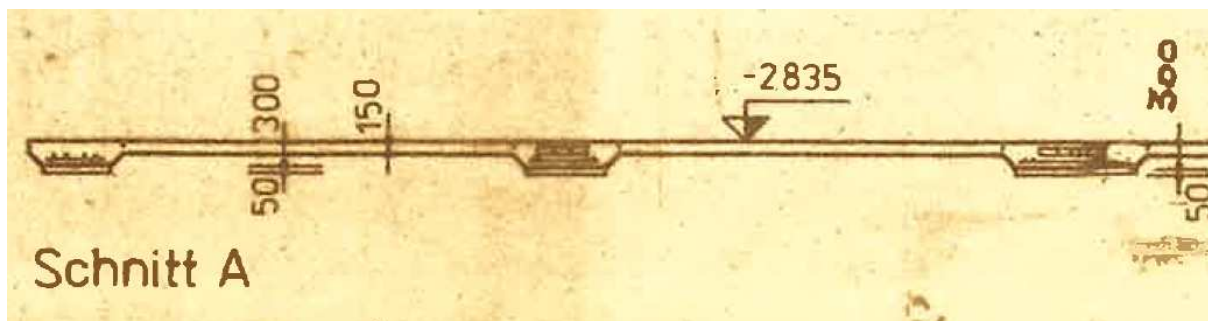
Systemschnitt aus /U.6/ mit Bewehrungsstreifen und Verstärkung der Gründungsplatte unter tragenden Wandachsen
